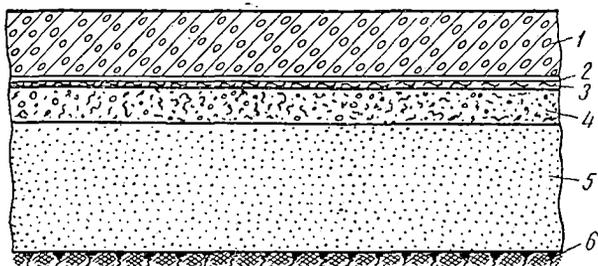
Конструкция дорожной одежды с цементнобетонным покрытием:
